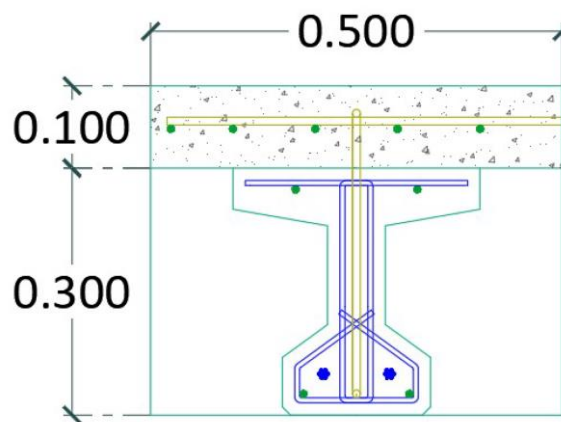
Detalle de la sección compuesta sobre una viga
